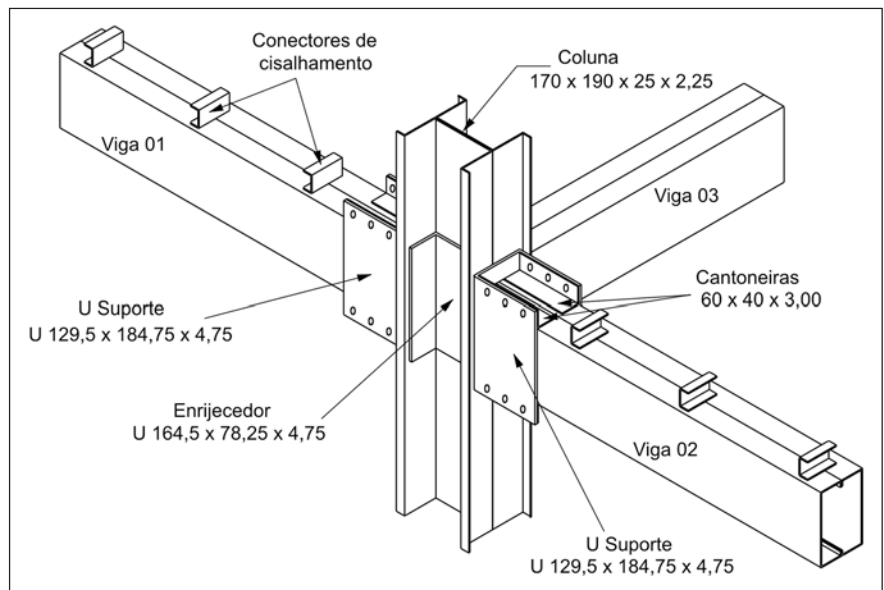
Detalhamento da ligação proposta (dimensões em mm).
